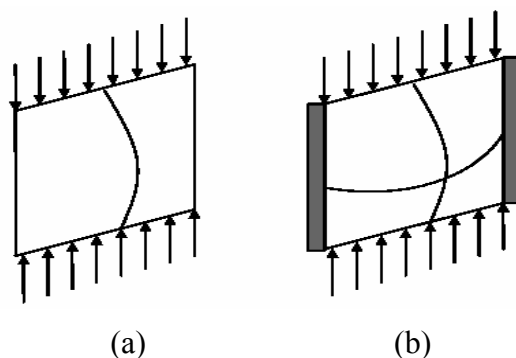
(a) Flexão de painéis em um plano ortogonal e (b) flexão em dois planos ortogonais
